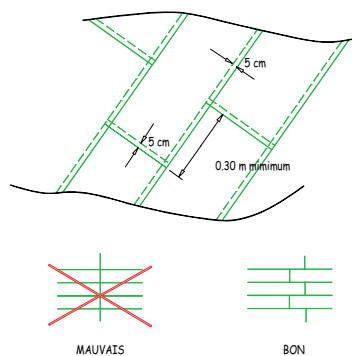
Dispositions relatives à la soudure des lès
